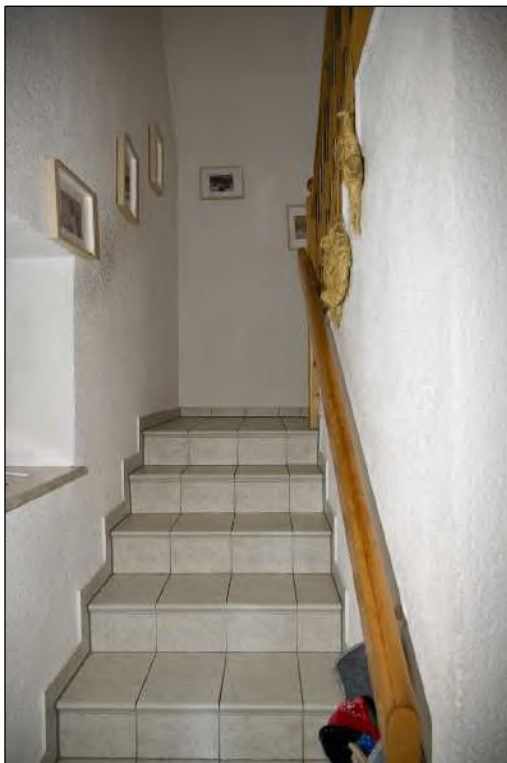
Erdgeschoss - Treppe zum Dachgeschoss
